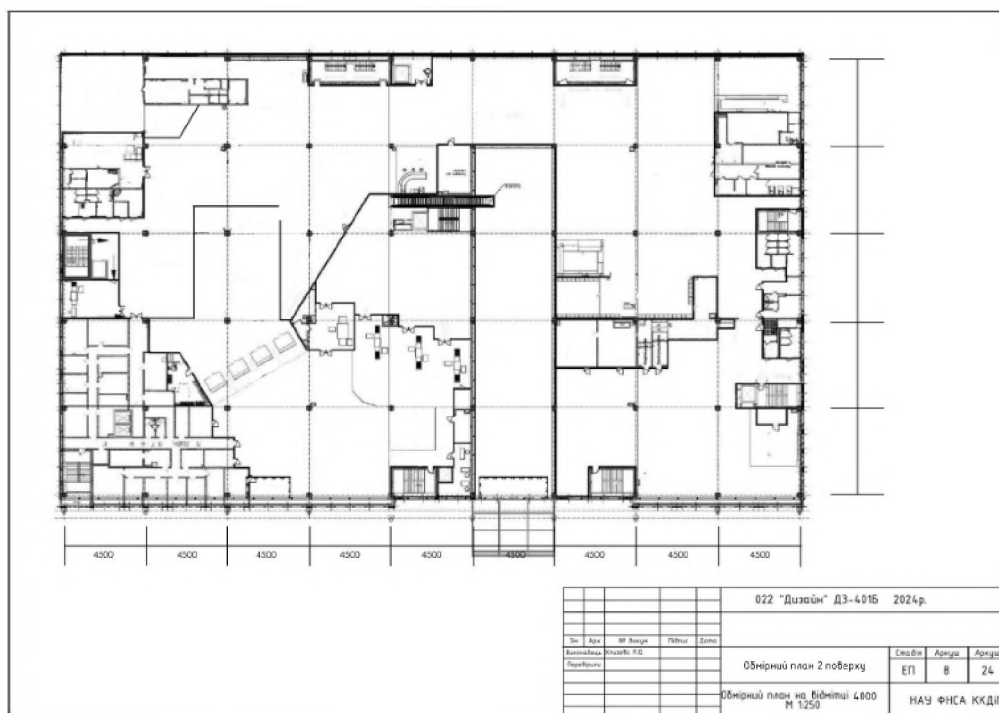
Вихідні дані: планування другого поверху аеровокзалу "Київ". Генплан
